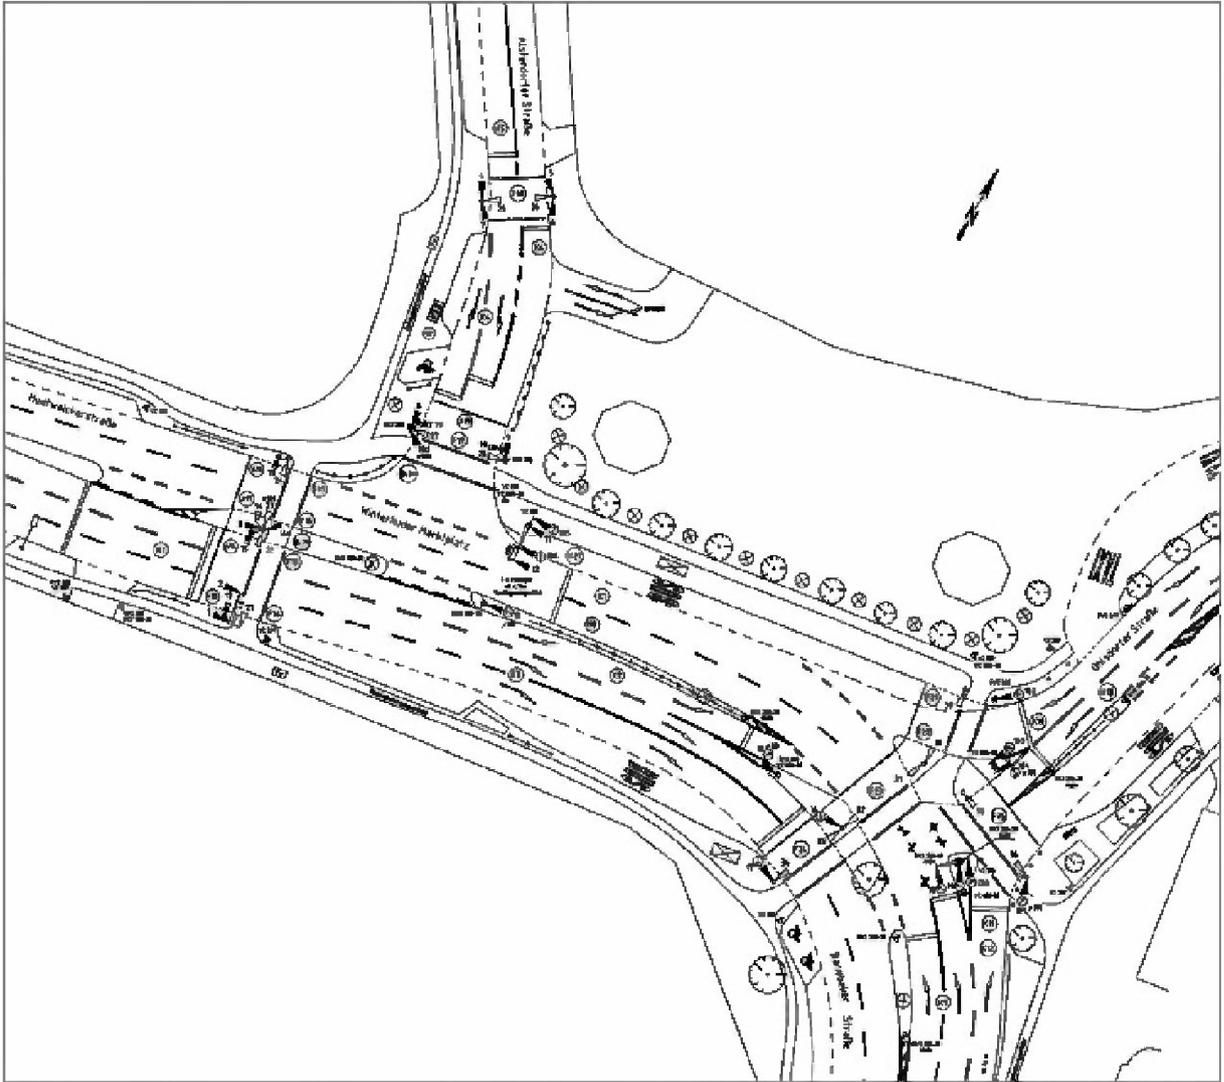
5 Signallageplanausschnitt LSA 44
